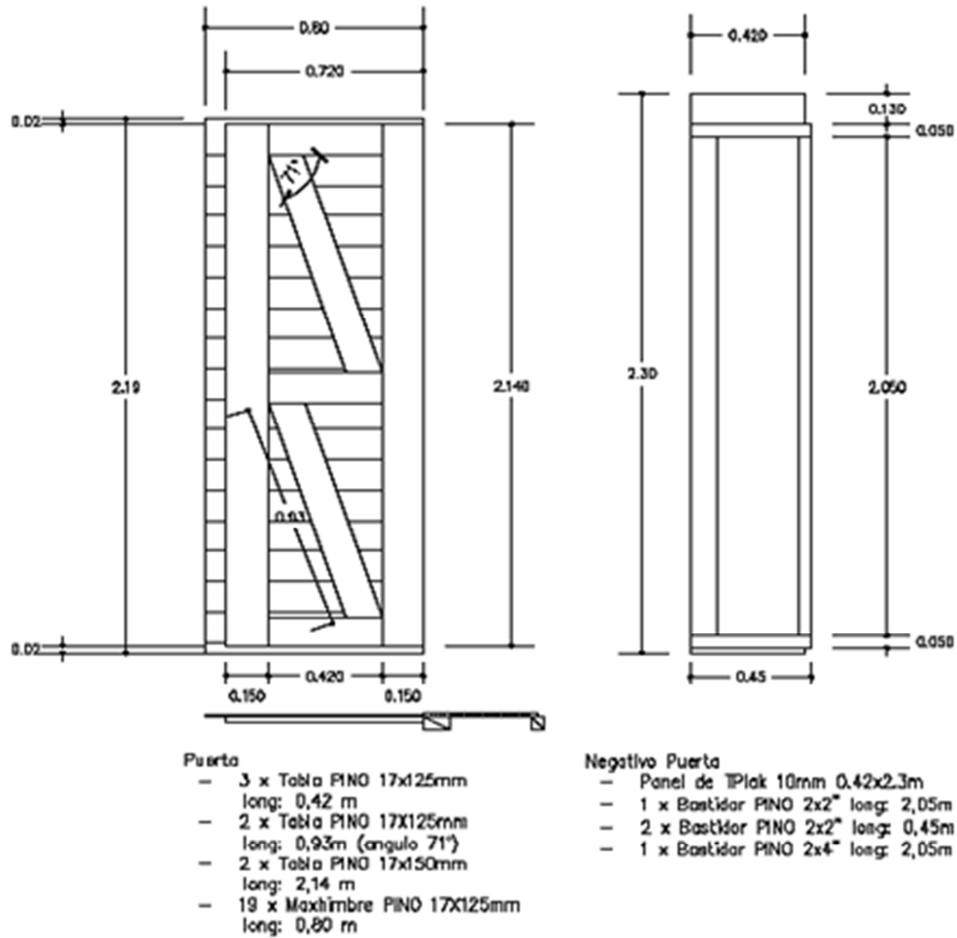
Detalle constructivo de la puerta. Fuente: Documentación provista por TECHO.
